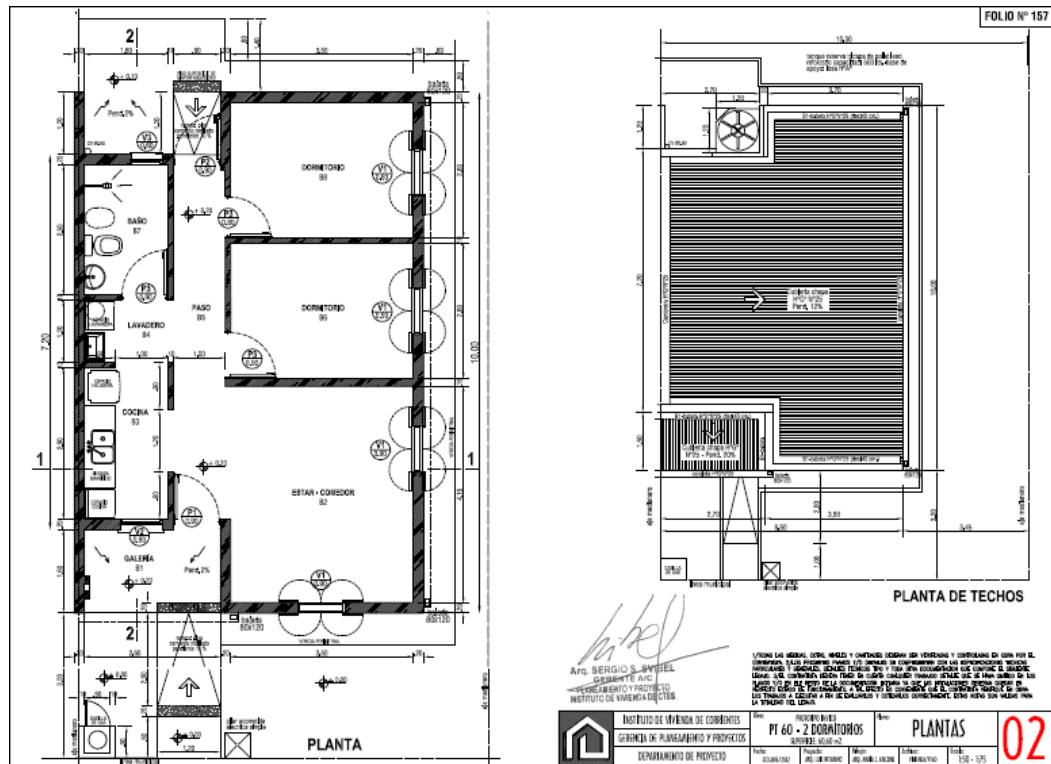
Planta del Prototipo Universal, construido en el barrio Concepción.
